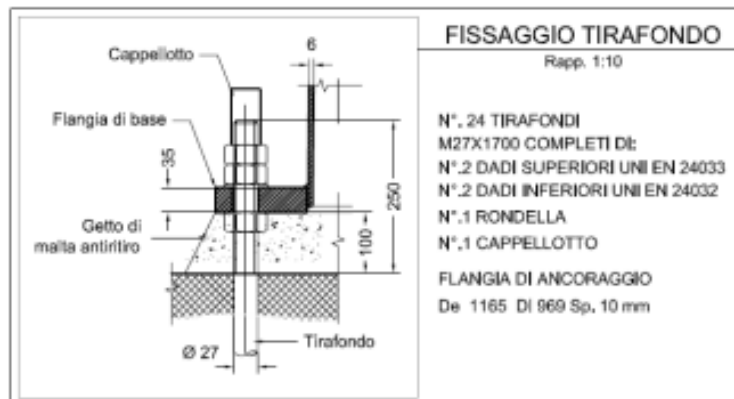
Schema rappresentativo del fissaggio del palo alla fondazione tramite tirafondo.
